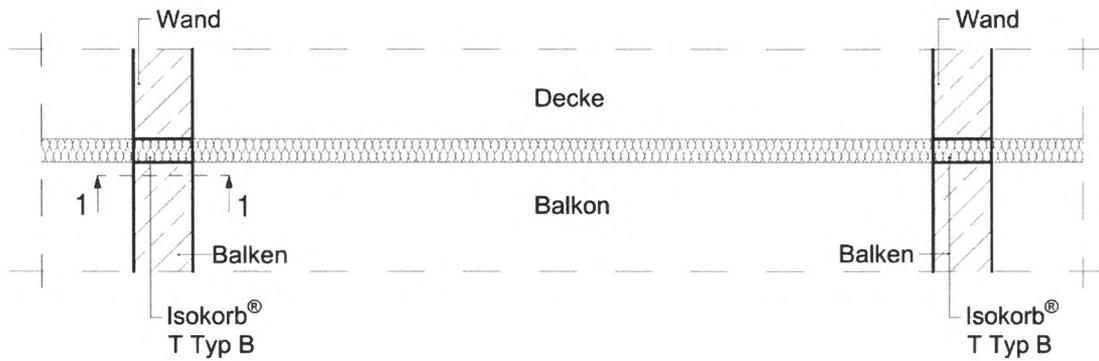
Einbausituation Schöck Isokorb® T Typ B 5.0
